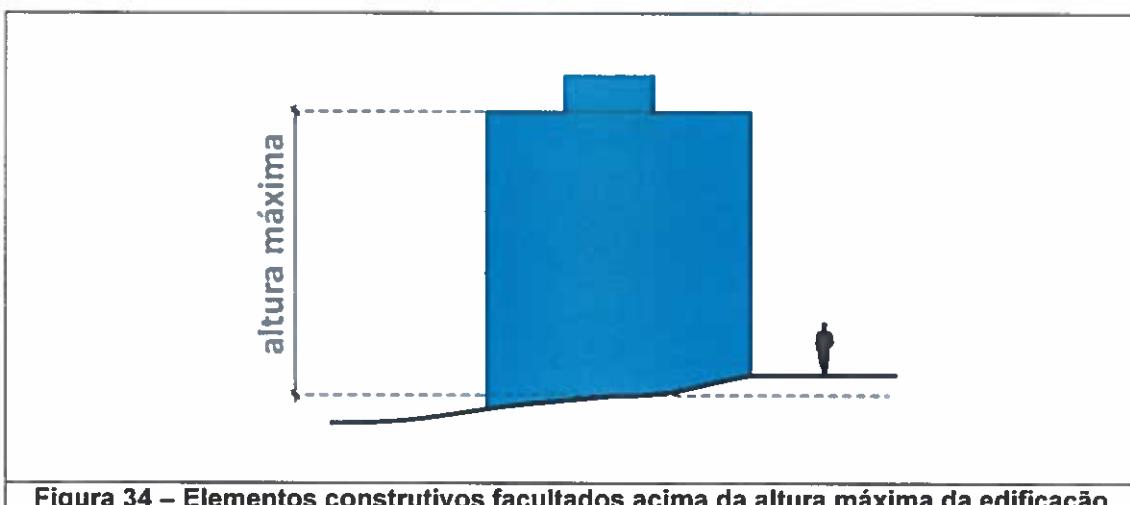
Elementos construtivos facultados acima da altura máxima da edificação
